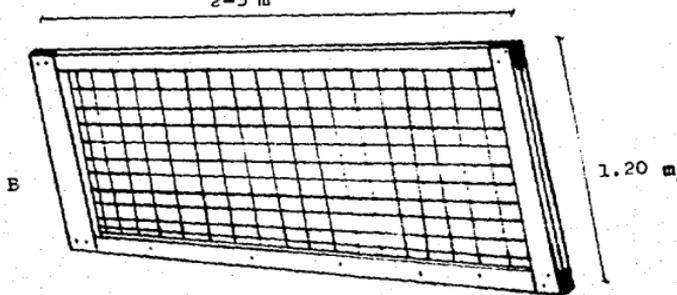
a. Puerta Construida con madera de 1/2" o 3/4" de grosor por 6" de ancho.
